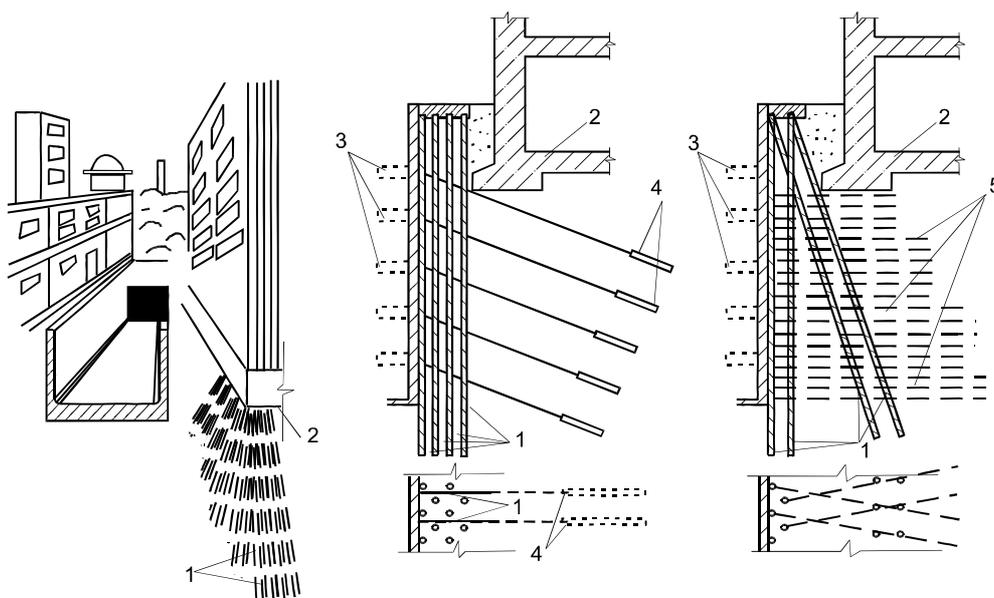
Ограждения стенок котлованов армоконструкциями из многорядных буринъекционных свай: 1 – сваи; 2 – фундаменты существующих строений; 3 – распорки; 4 – анкера; 5 – нагели (вариант нагельного крепления)
